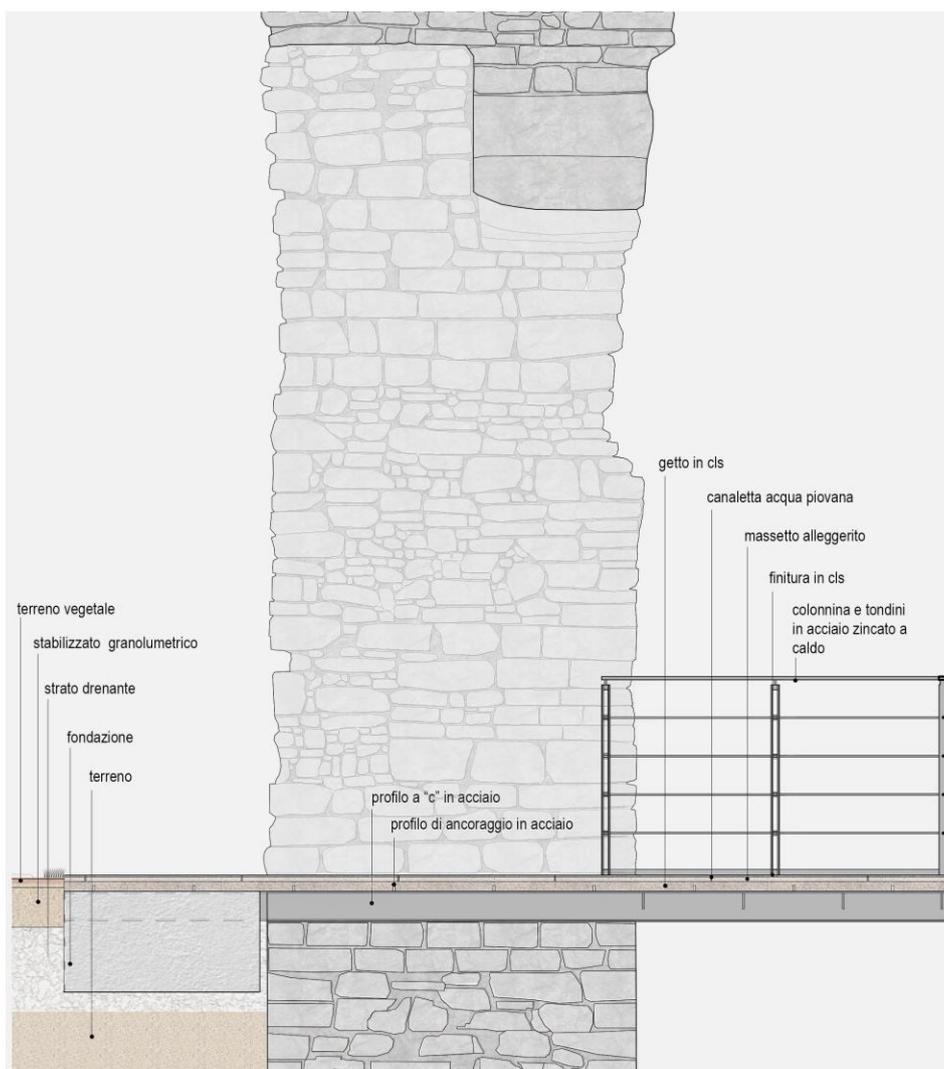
Sezione struttura a sbalzo in acciaio.
